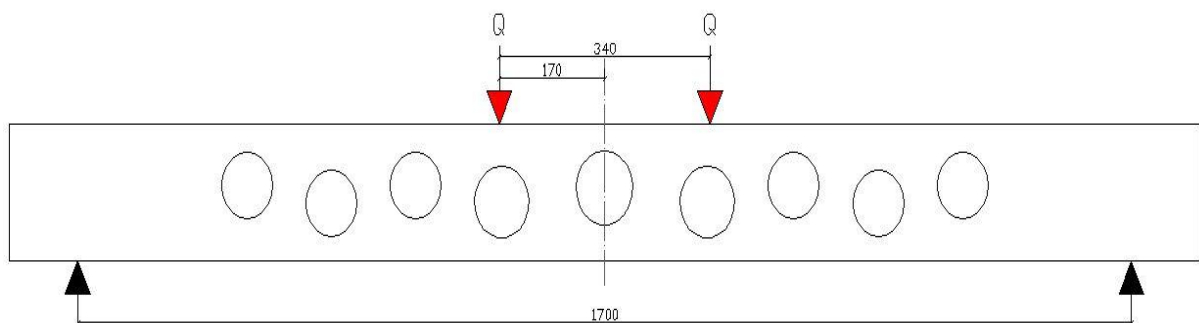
6 Esquema ensayo vigas aligeradas mediante dos cargas y dos apoyos
